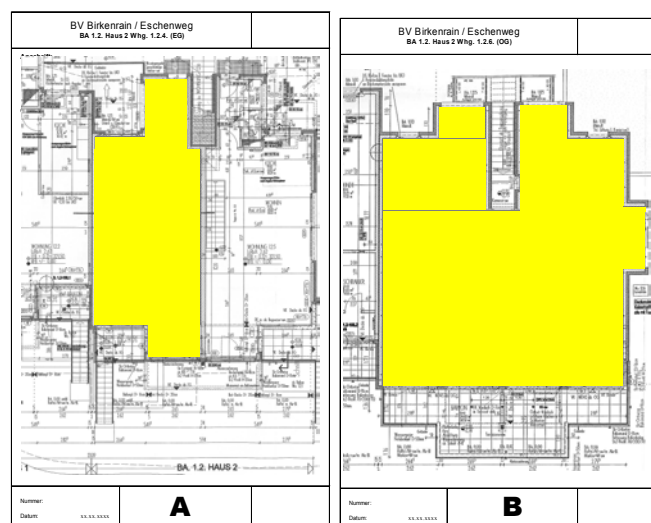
Grundrisse von 2 Wohnungen in einem Haus
